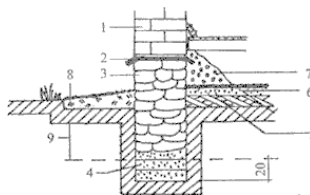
Ленточный фундамент из бутового камня: 1 – кирпичная кладка стены; 2 – гидроизоляция; 3 – бутовый камень; 4 – утрамбованная песчаная подушка; 5 – уплотненный грунт; 6 – песок; 7 – засыпка; 8 – отмостка; 9 – глубина промерзания.
